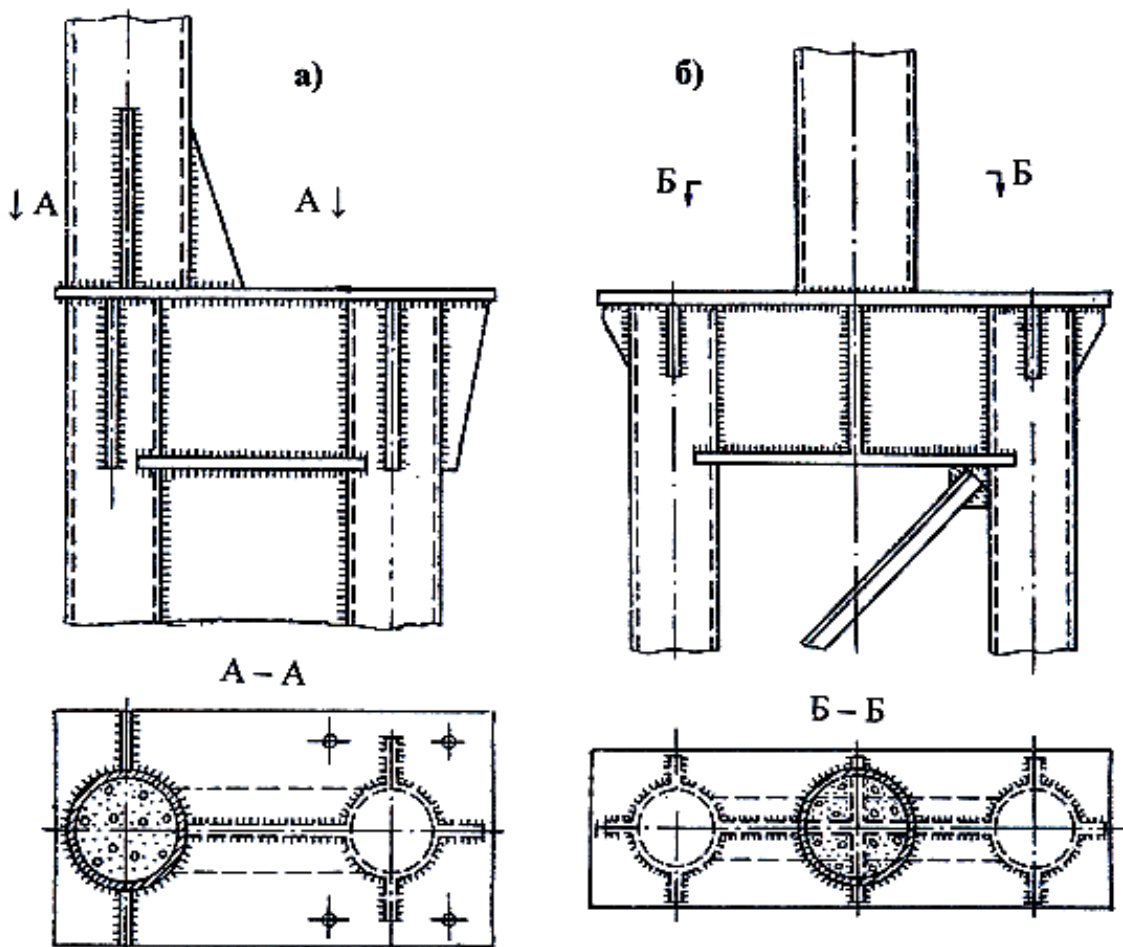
Соединения надкрановой и подкрановой частей и базы сплошных (а) и решетчатых (б) двухветвевых колонн [3]
